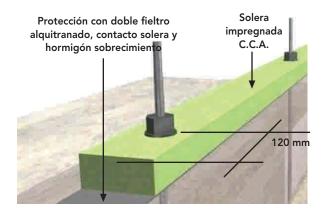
36: Detalle constructivo de la distribución de espárragos o barras de anclaje. Espaciamiento de 120 mm entre el último perno y el extremo del término del tabique.
